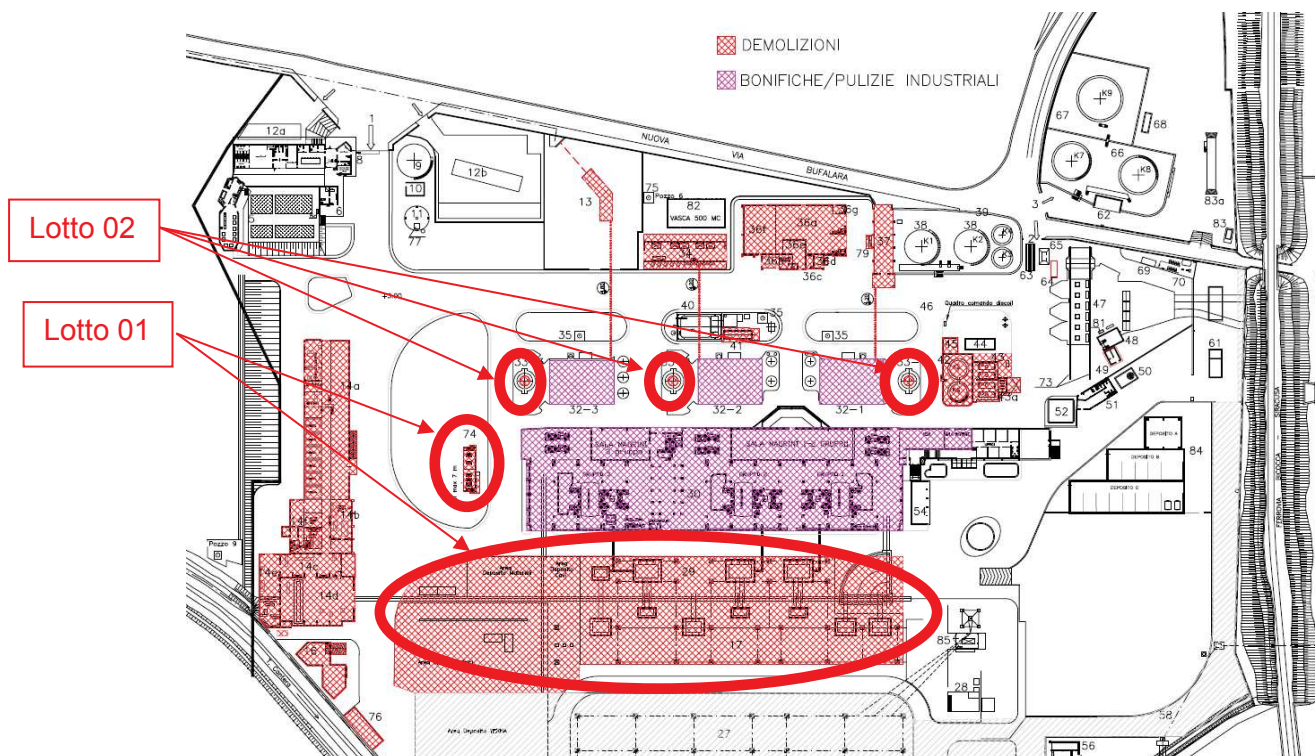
Planimetria di dettaglio Lotto 1 e 2
